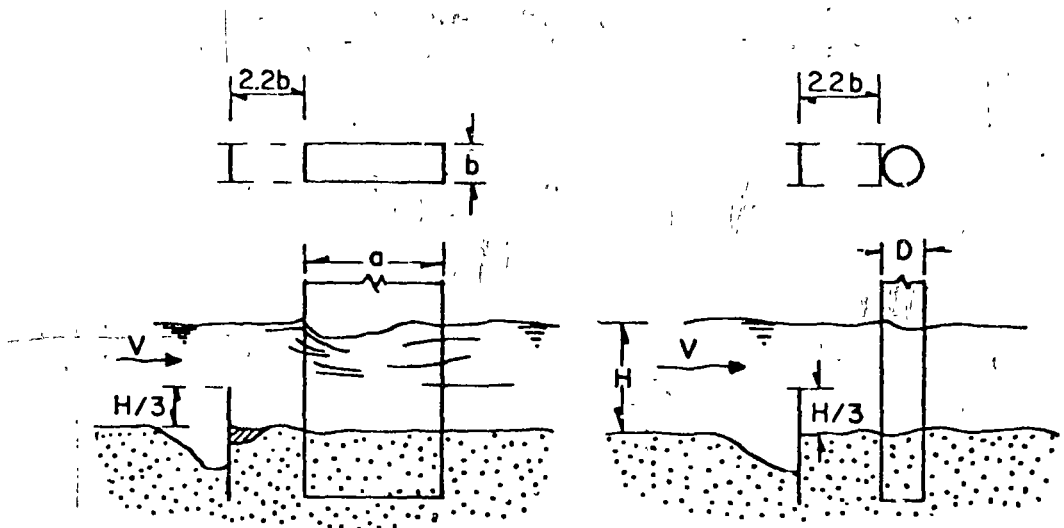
Colocación de las pantallas protectoras según Levi-Luna
